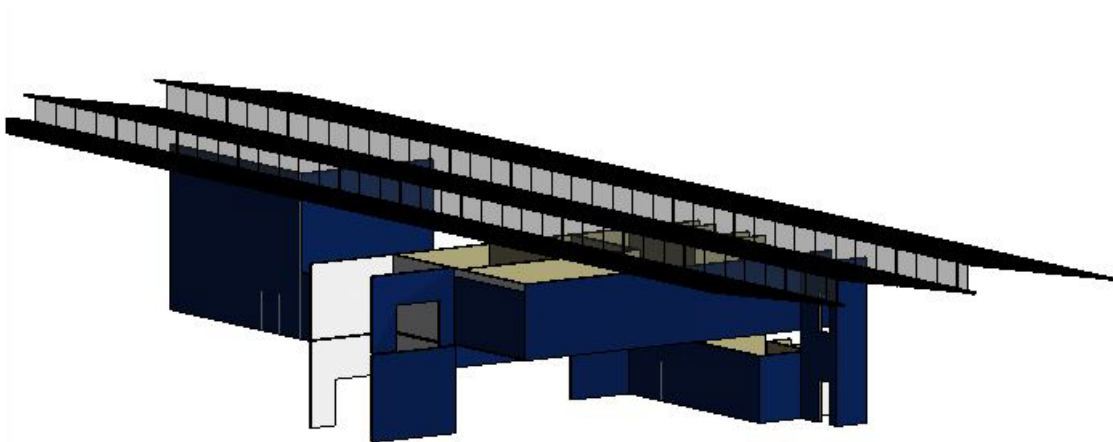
Fase 4: Tabiquería, panel Sandwich y lucernarios
